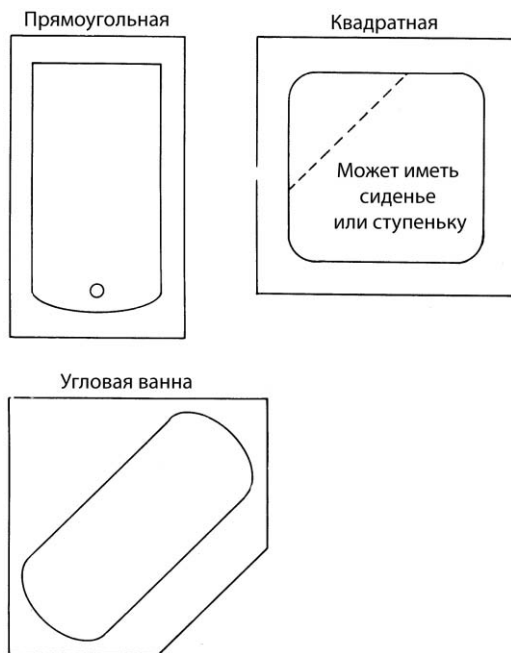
Три наиболее распространенные формы ванны — прямоугольная, для размещения в нише, квадратная и угловая. Площадь квадратной и угловой ванны больше, чем площадь прямоугольной
